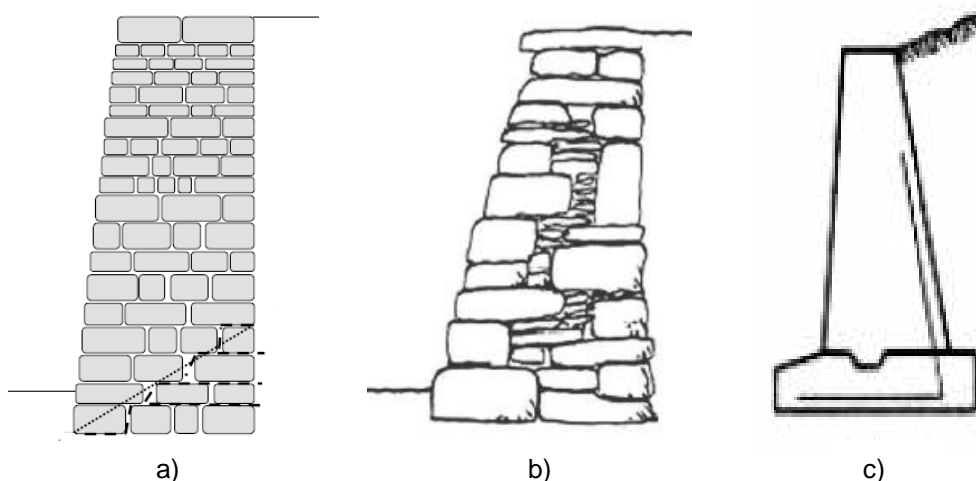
Exemplos de estruturas rígidas – a) Muro de alvenaria – b) Muro de pedra – c) Muro de Concreto armado.
